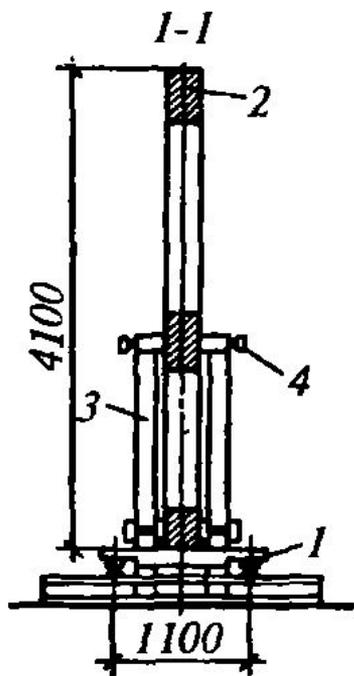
Стеллаж для укрупнения железобетонной фермы:
